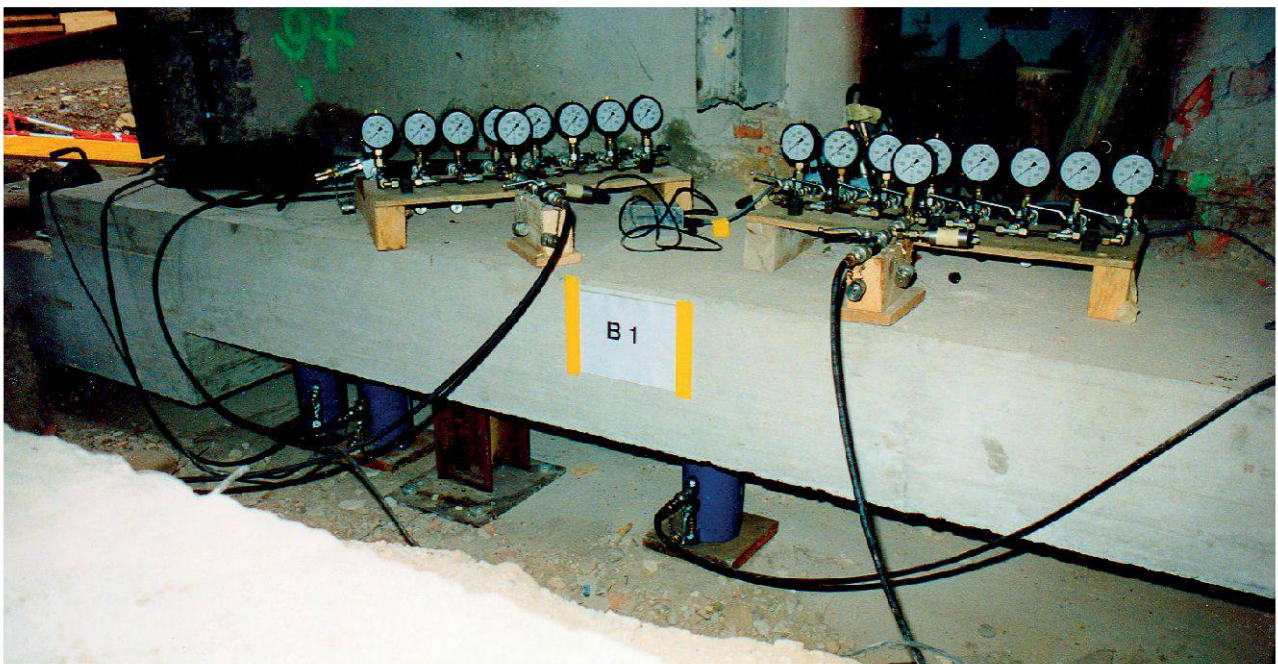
Unterfangung des Hauses Steigstrasse mit Bodenplatte und Anheben mit hydraulischen Pressen (Foto S. Frank).
